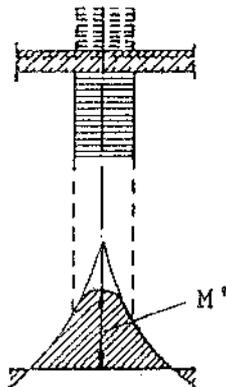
Reducción del diagrama de momentos flexores sobre un apoyo en el cual la pieza no está rígidamente conectada, por ejemplo en el caso de apoyo sobre una pared.
